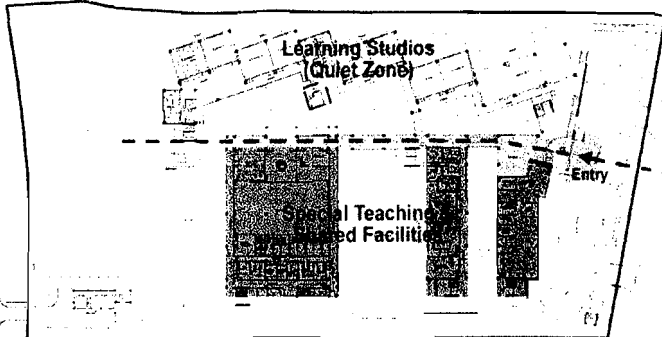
Contoh Penciptaan Ruang Outdoor.
